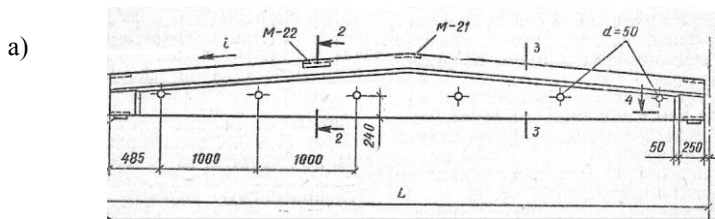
Железобетонные балки пролетом 6, 9 и 12 м:
